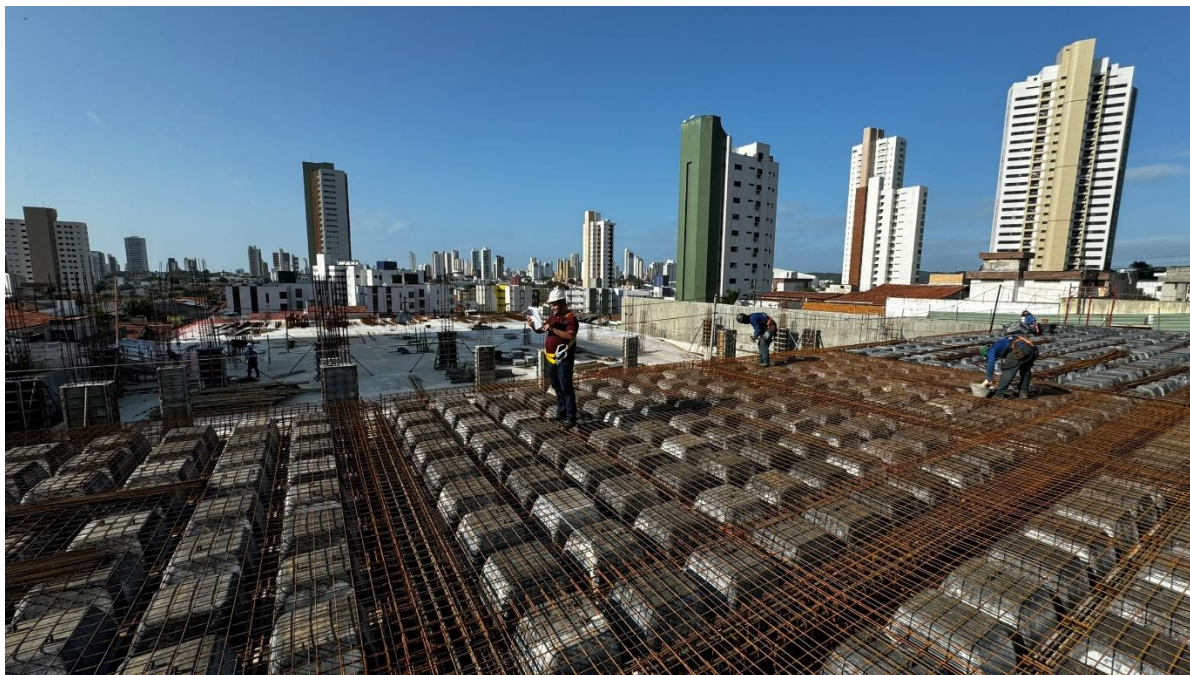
Local da laje de cobertura do segundo subsolo onde foi concretada a oitava etapa.
